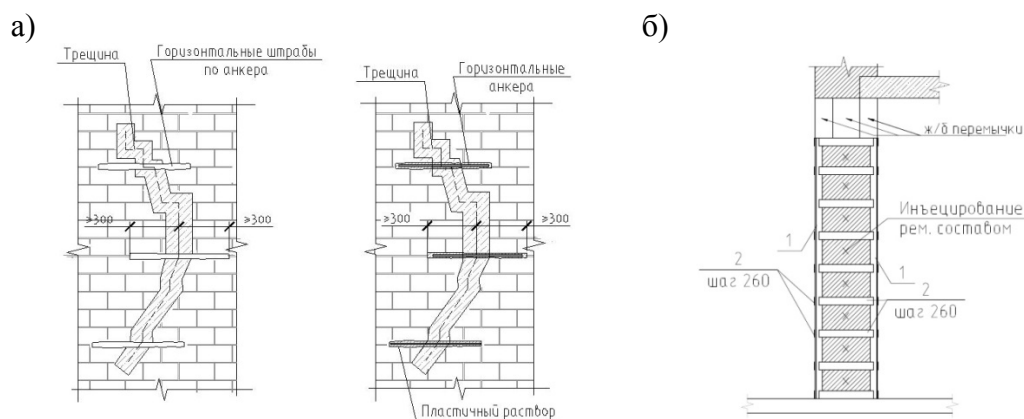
а) армирование стальными анкерами, б) устройство стальной обоймы
